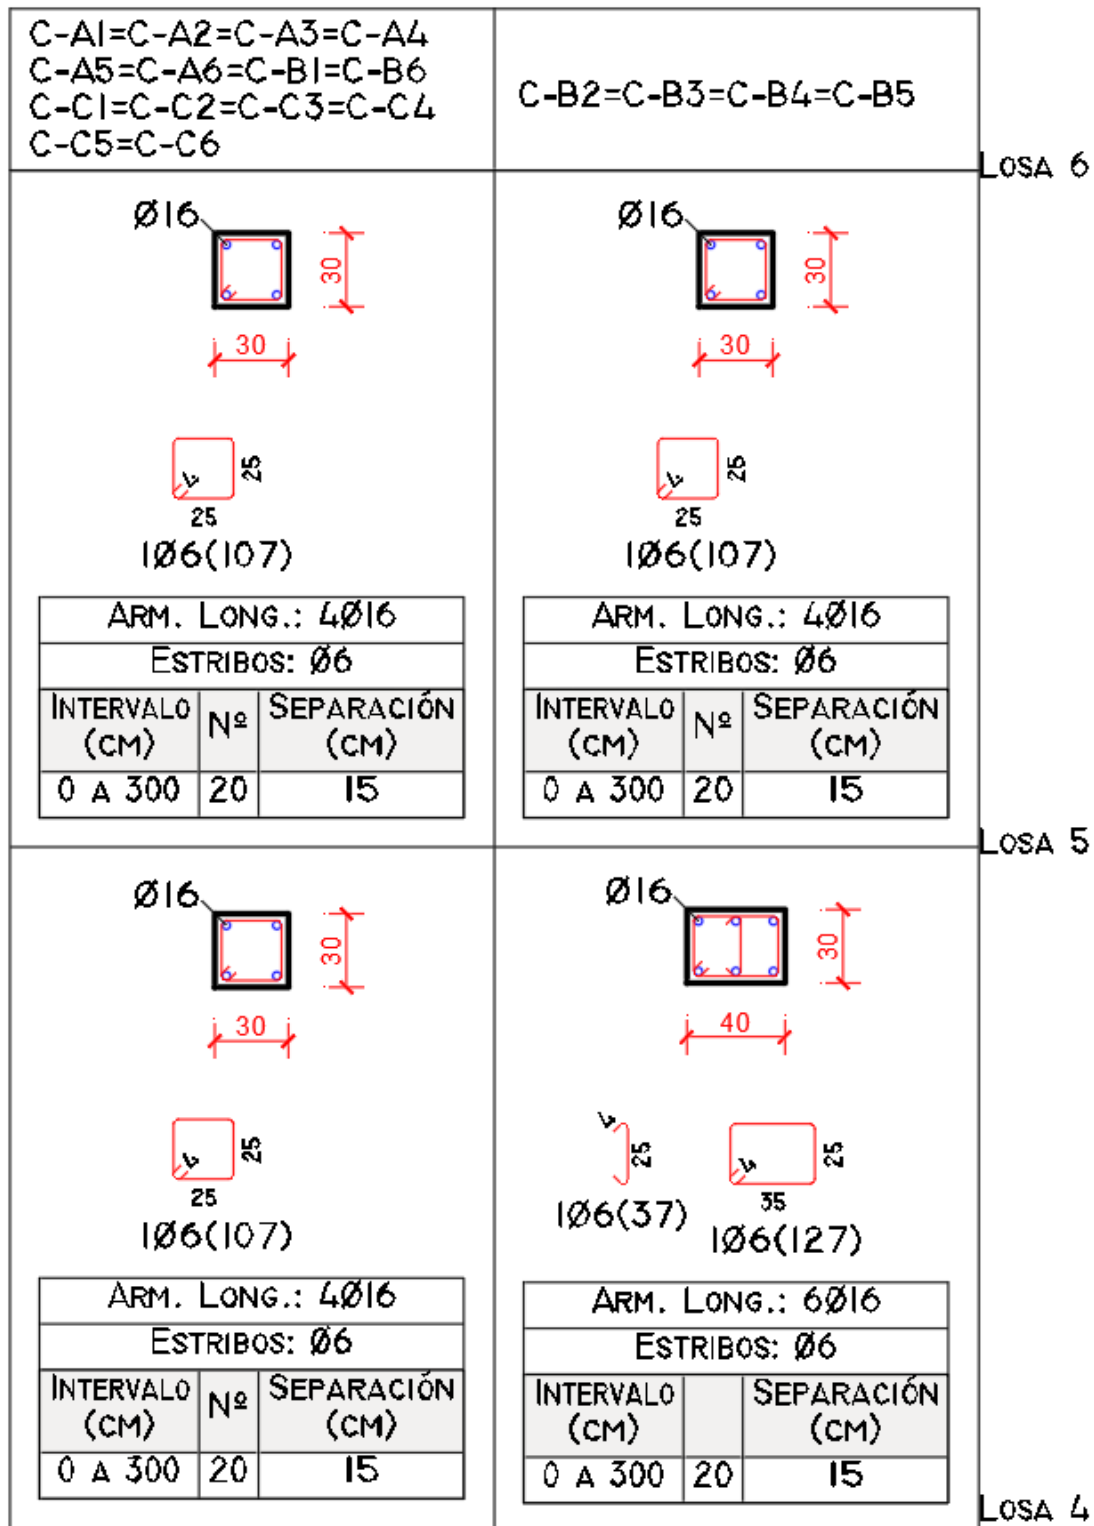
Detalle de Refuerzo Columnas, de Losa 4 a Losa 6, Estructura [7N-SS].
